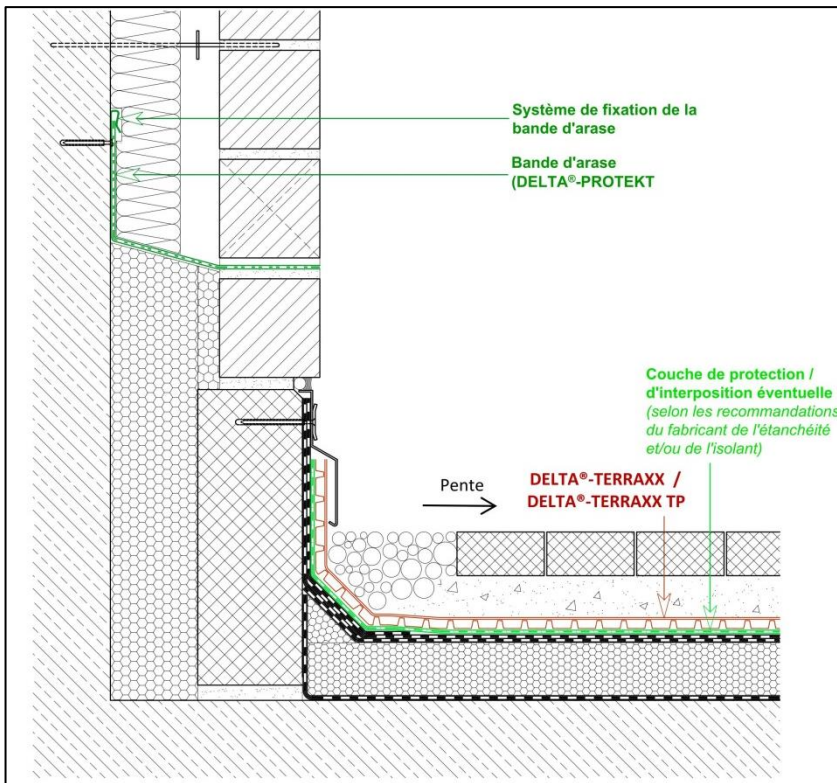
traitement des relevés en façade avec membrane d'étanchéité bitumeuse + DELTA®-TERRAXX / DELTA®-TERRAXX TP (protection lourde avec dalles ou pavés) – exemple 1
